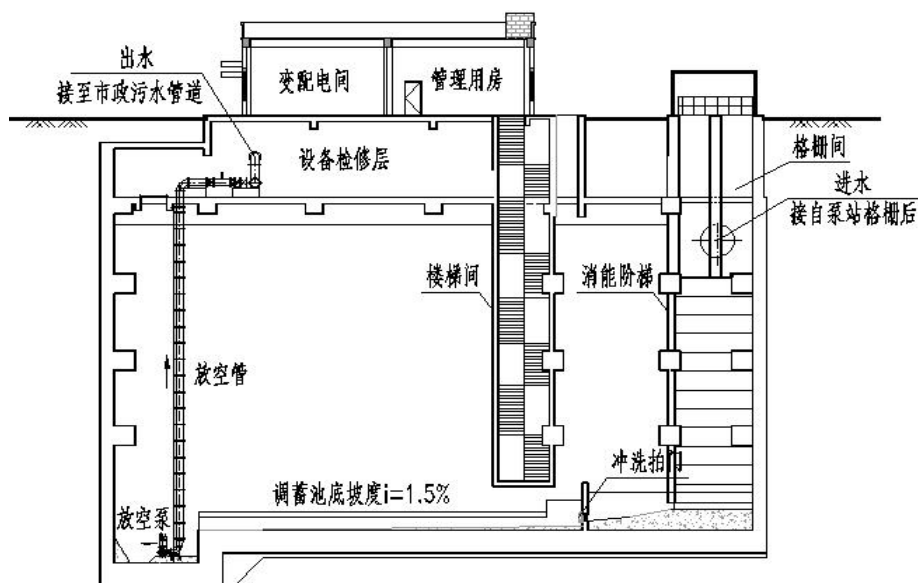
全地下式钢筋混凝土调蓄池立面示意图
